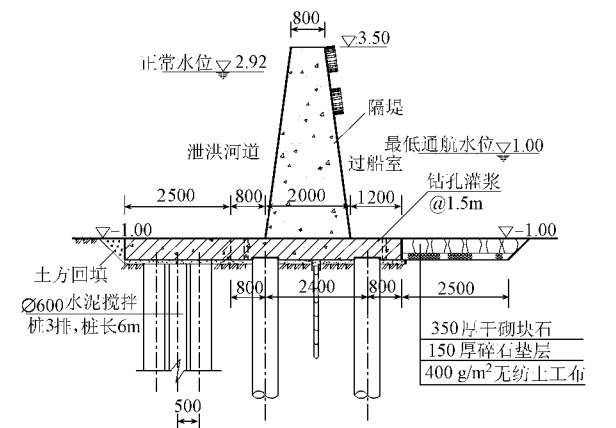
搅拌桩防渗方案断面(高程单位:m,尺寸单位:mm)
